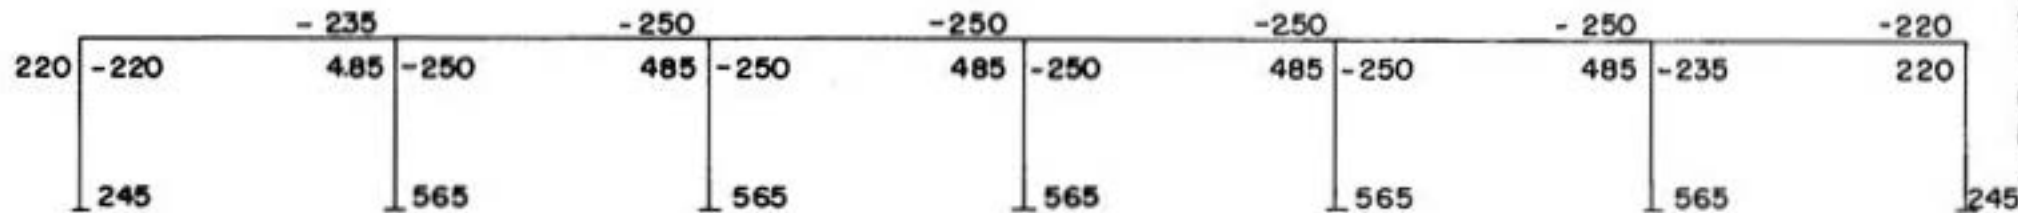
CALCULO DE LA VIGA VA-5. HARDY CROSS.
